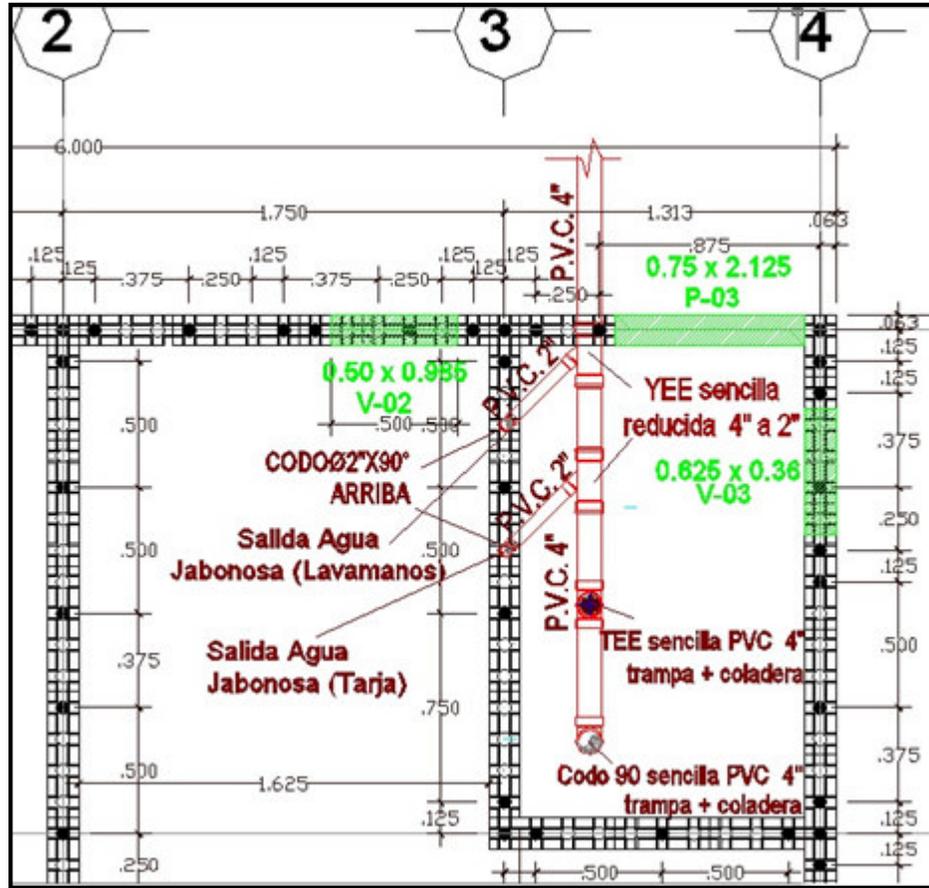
Plano tipo de separación de aguas jabonosas.
